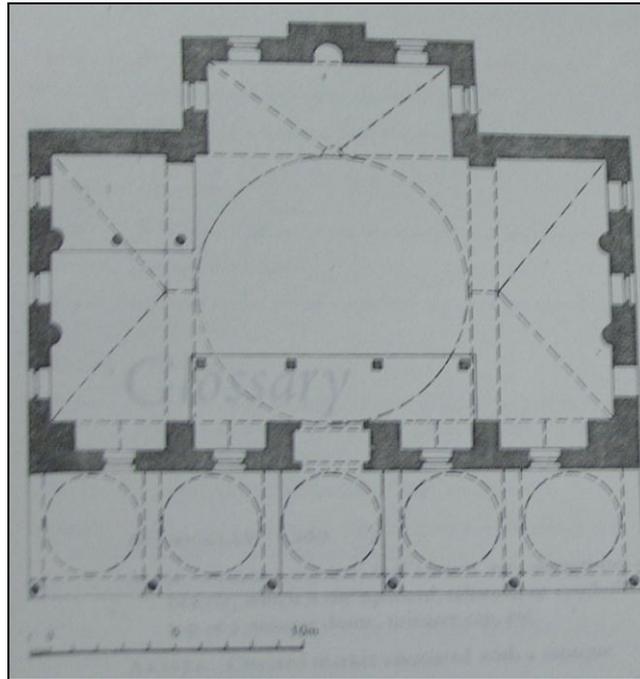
المسقط الأفقي لمسجد ماهريماه - استانبول
